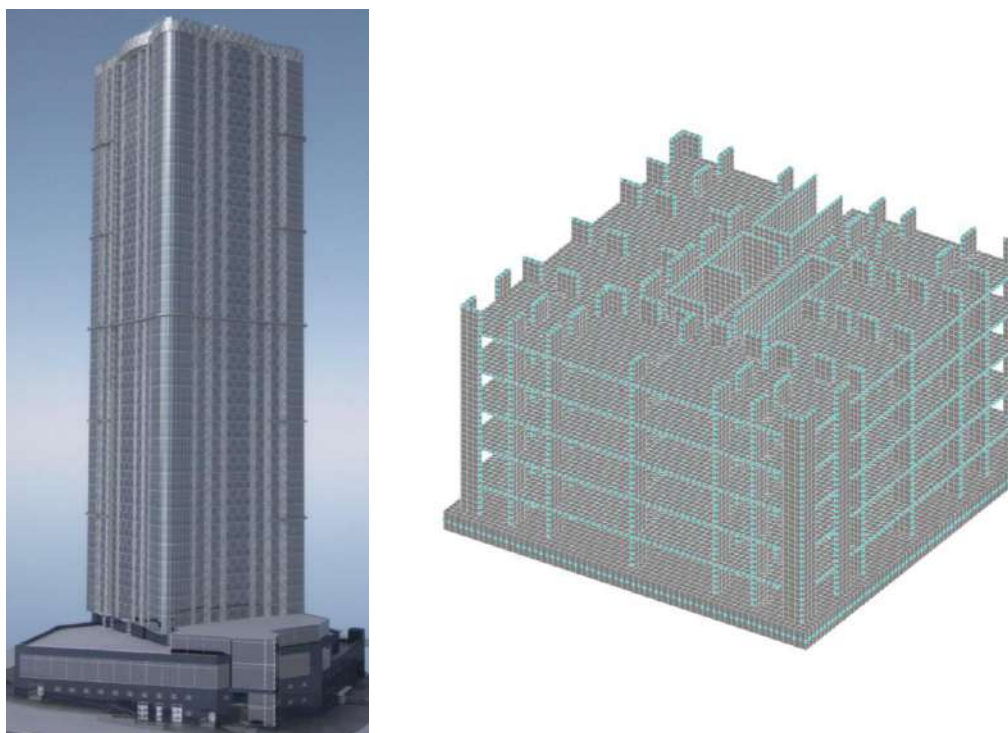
Общий вид здания и фрагмент расчетной схемы
